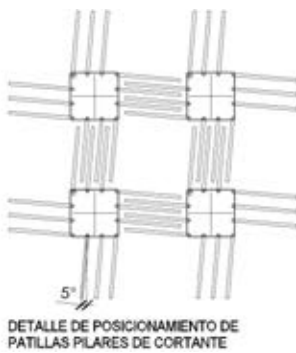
Disposición de armado de torretas de cortante y plantilla de armado. Detalle de paso de armado longitudinal inferior entre las barras verticales de las torretas de cortante, en zona de solapo.
